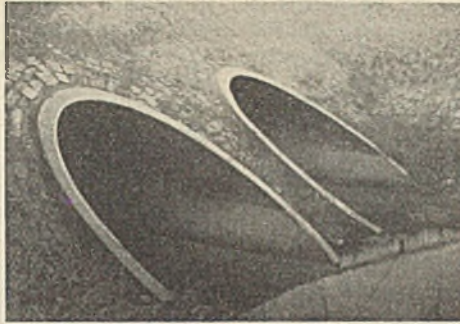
Durchlaß aus Schleuderbetonrohren
